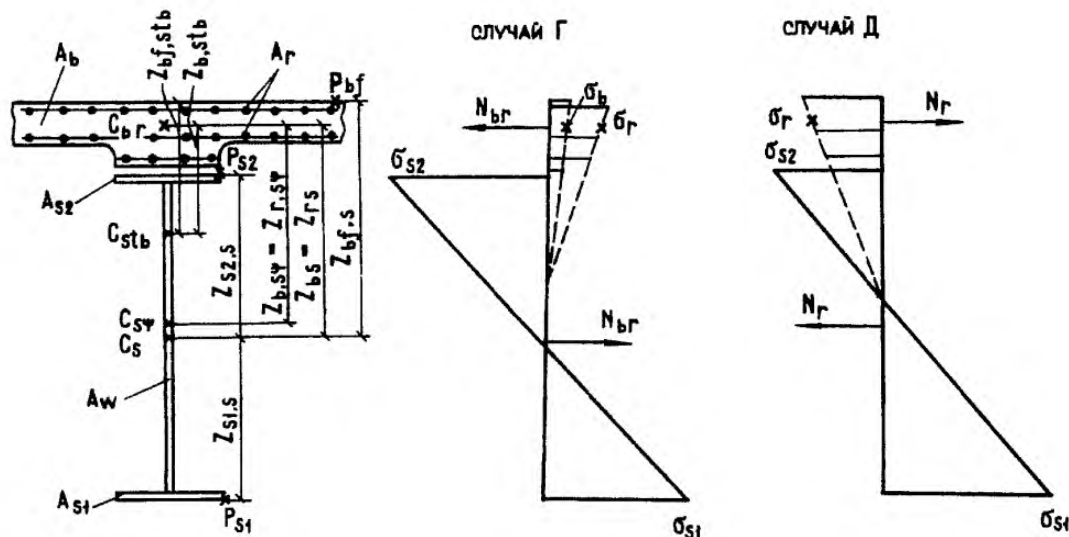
Усилия и напряжения в сталежелезобетонном поперечном сечении, воспринимающем отрицательный изгибающий момент
